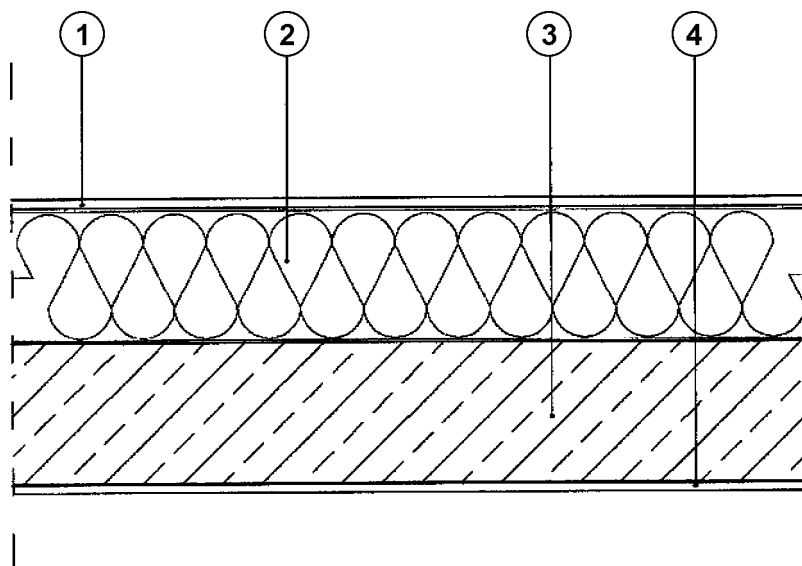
Przekrycie dachowe na płycie żelbetowej z izolacją cieplną z płyt styropianowych
